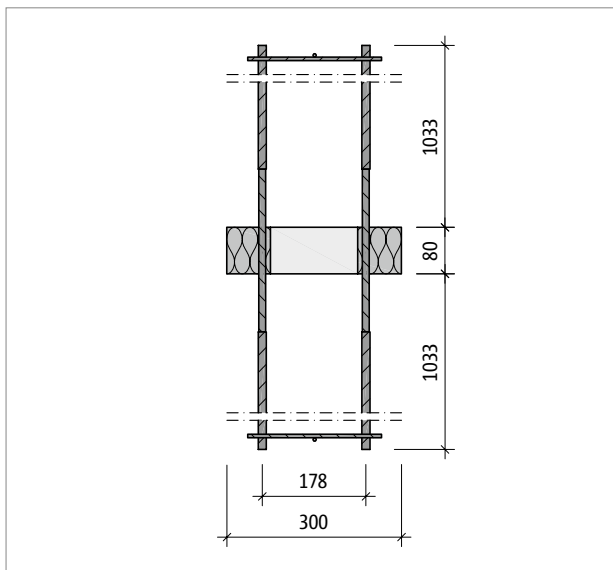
Schöck Sconnex® type W-N1T1-LW : coupe B-B du produit
